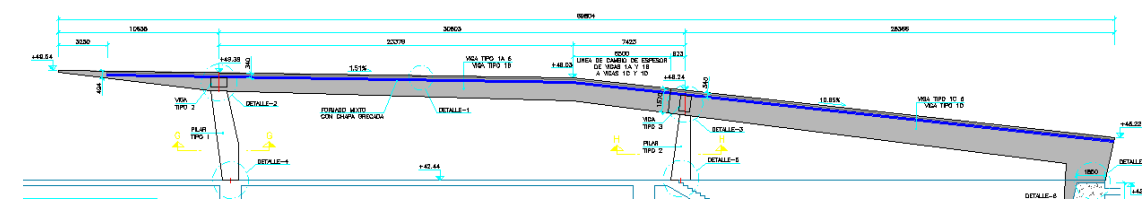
Sección longitudinal de la cubierta (fuente: PC estación El Carrizal)
